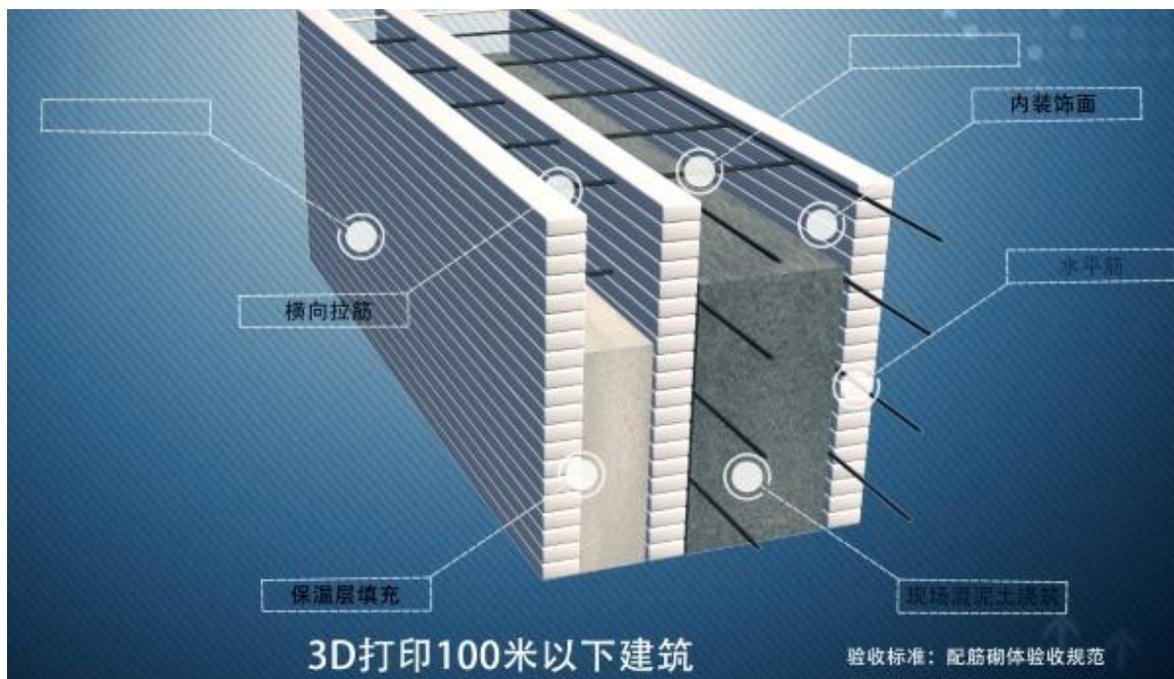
Estándar de construcción para edificios de menos de 100 metros de altura
